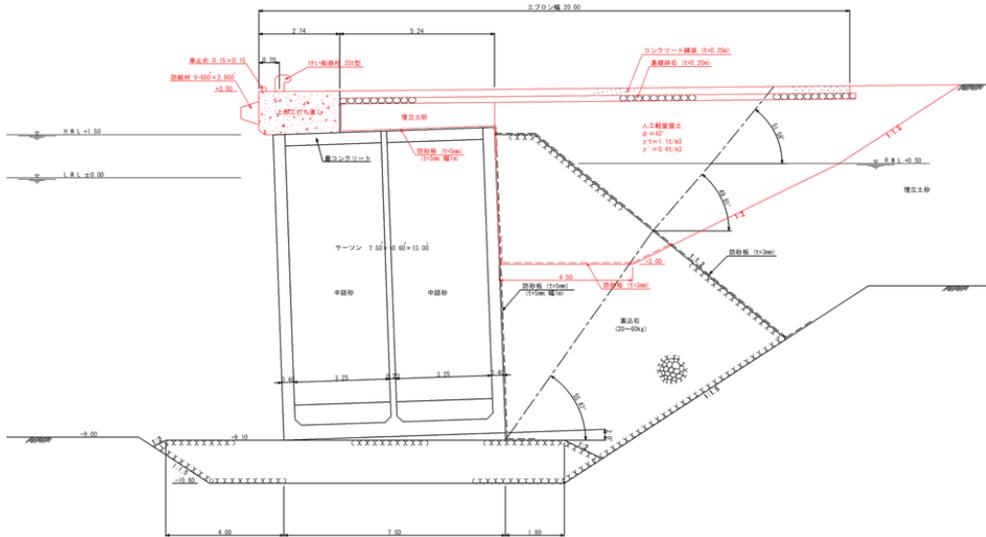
No.35 大洗港区_第4ふ頭地区岸壁 (-9.0m) の断面図 (復旧後)
